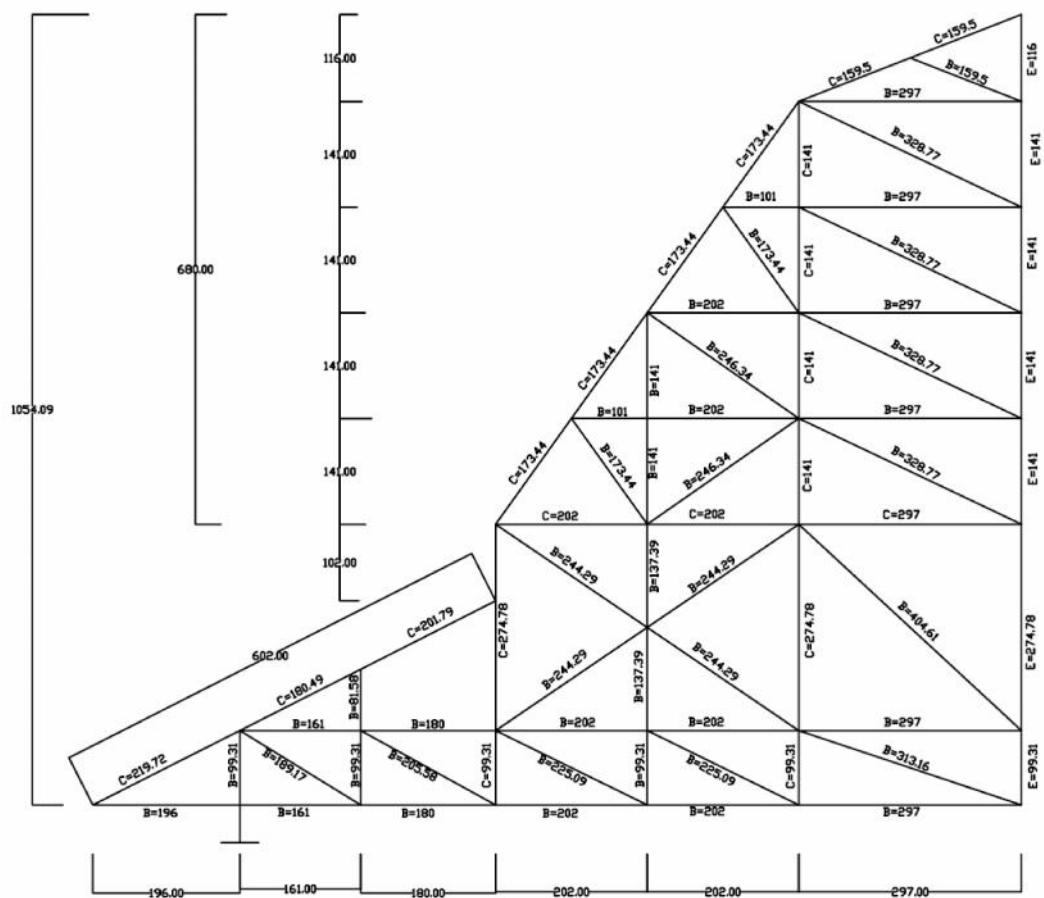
Potongan Melintang Jurai Rangka Baja
